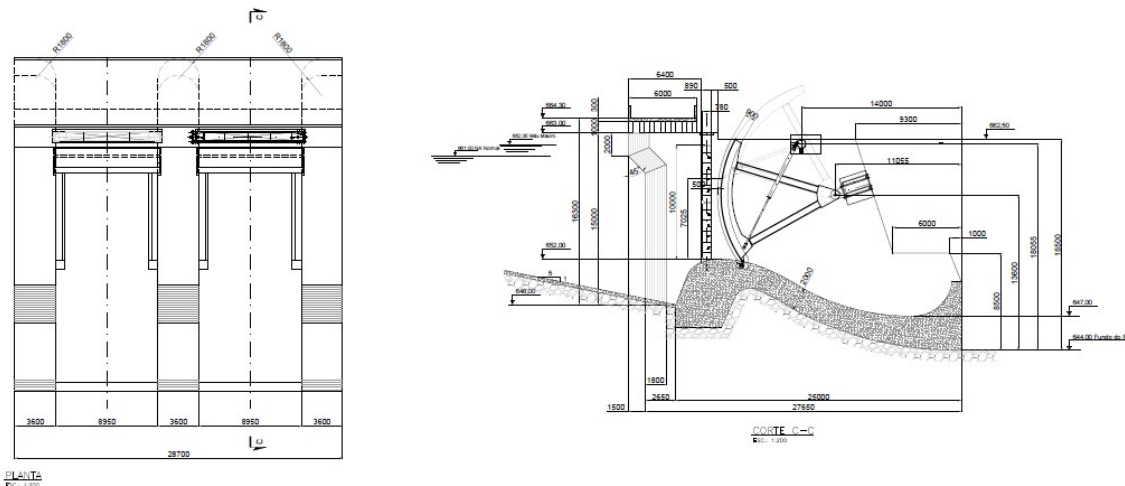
Fragmento do desenho de lay out da alternativa 1, mostrando planta e corte da estrutura de concreto
